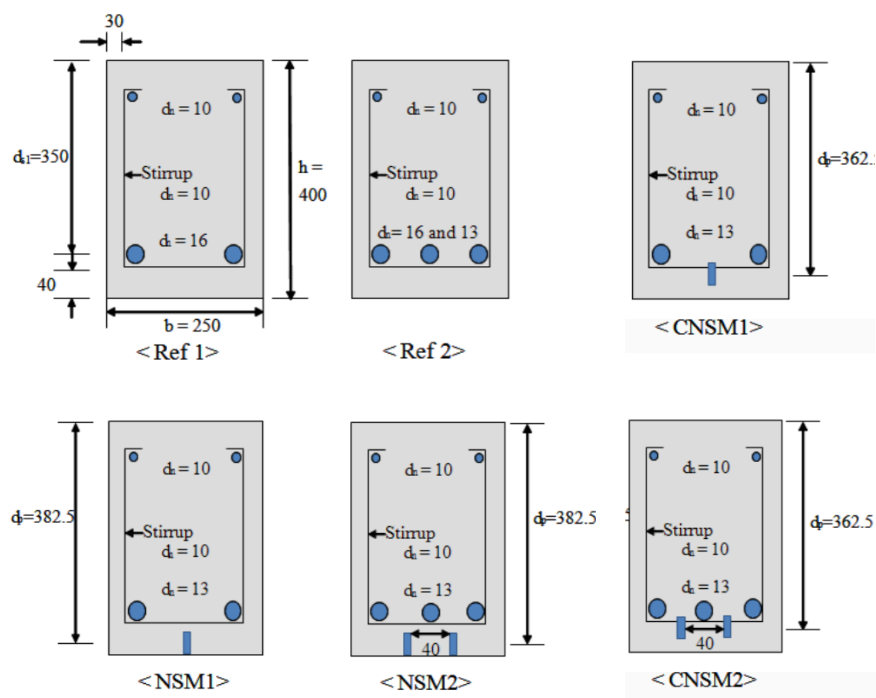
Geometria das vigas (Fonte: Moon *et al*, 2005)
